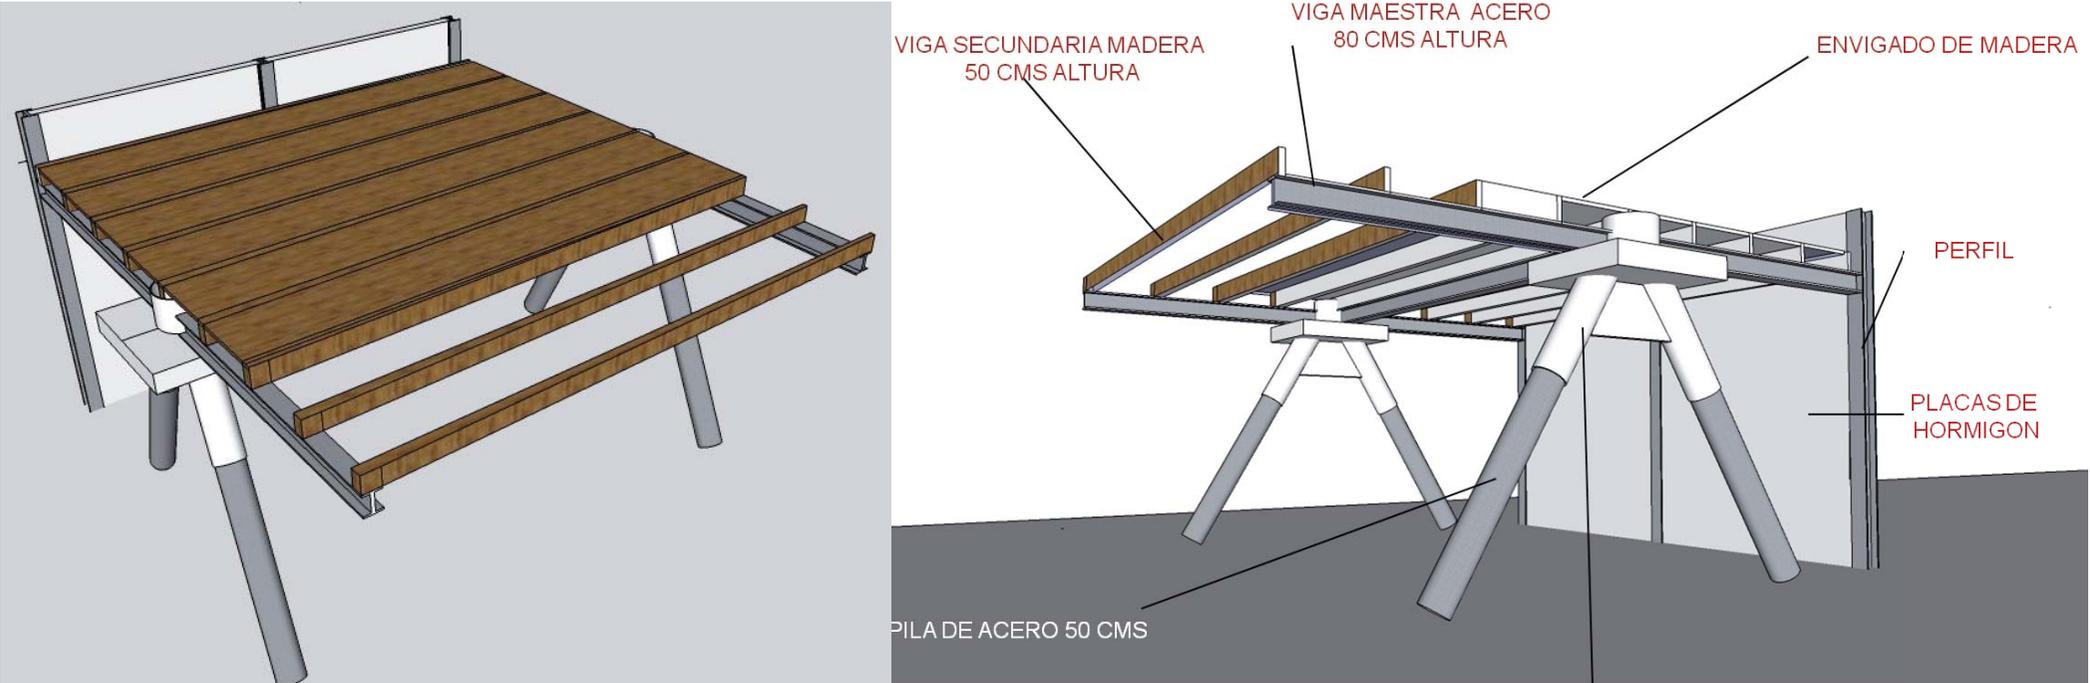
Solución constructiva y detalle de la estructuración de la losa.
